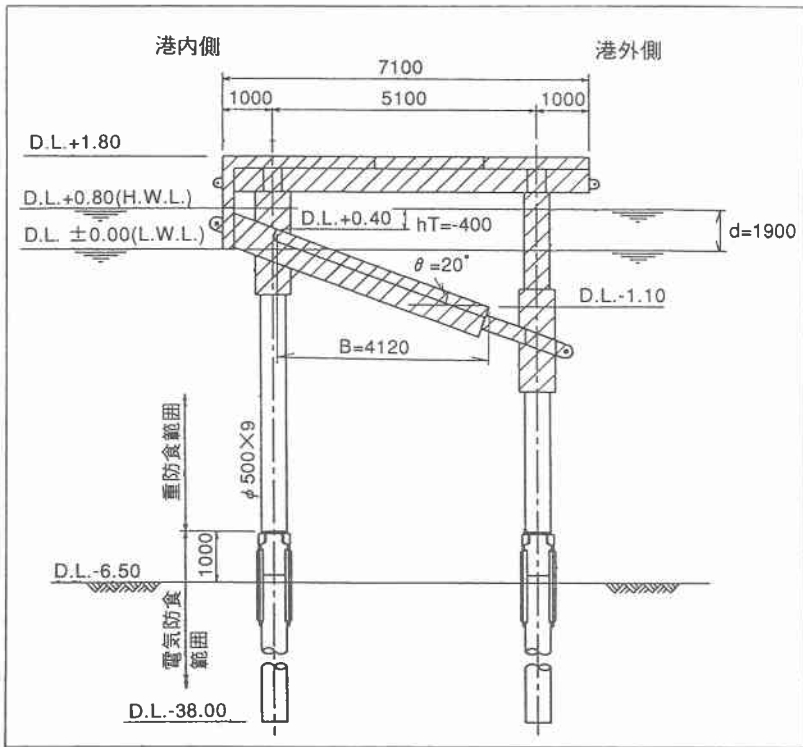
呼人漁港西防波堤の標準断面図 [ 係船タイプ ]
